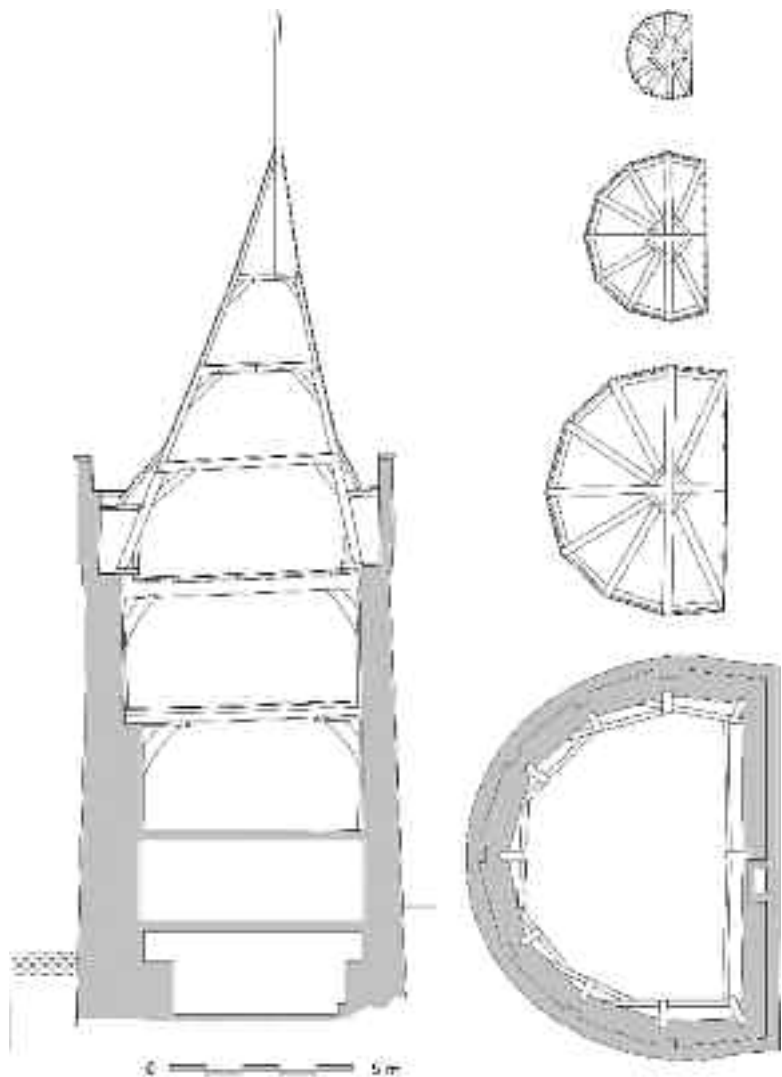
Grundrisse und Schnitt des Schreierstoren, 2005.
